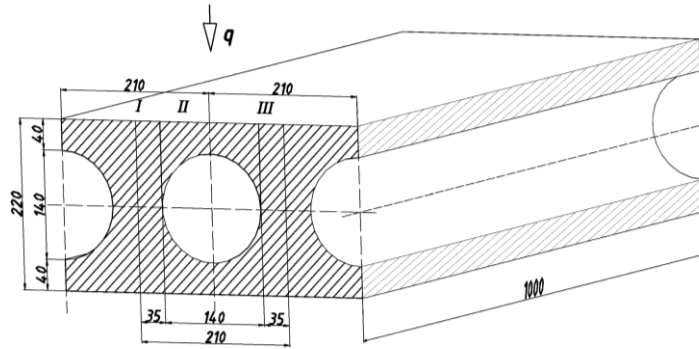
Эскиз элемента многопустотной плиты перекрытия
